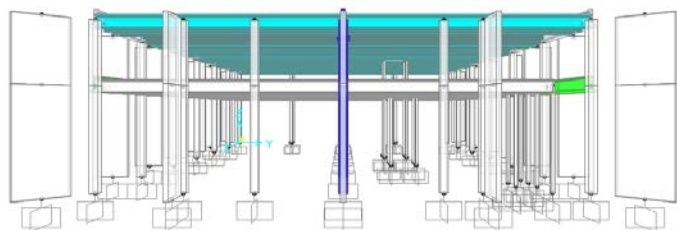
Prospetto trasversale del modello FEM della soluzione di adeguamento sismico progettata.
